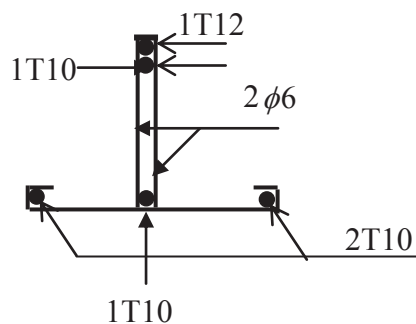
Schéma de ferrailage des poutrelles du plancher terrasse inaccessible
